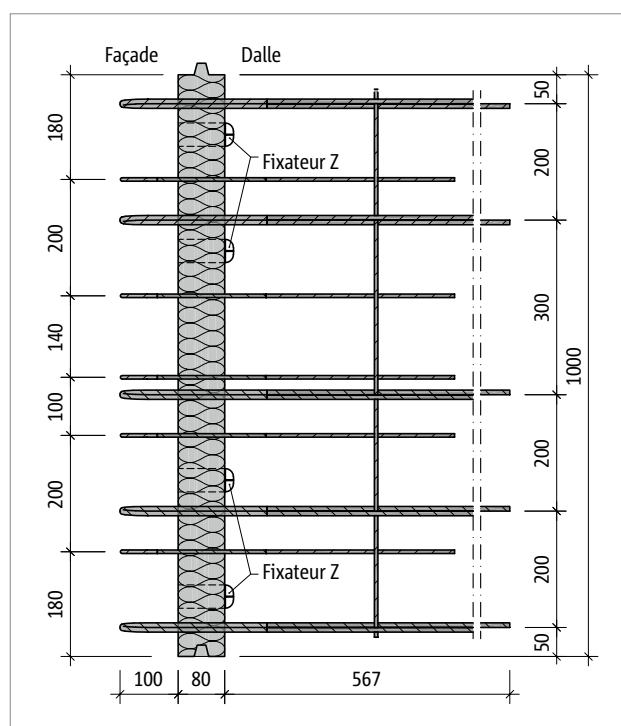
Schöck Rutherma® T type DFi-V4-LR100 : vue en plan du produit
